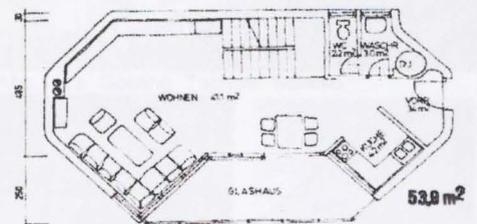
Markt Hartmannsdorf, Grundrisse
